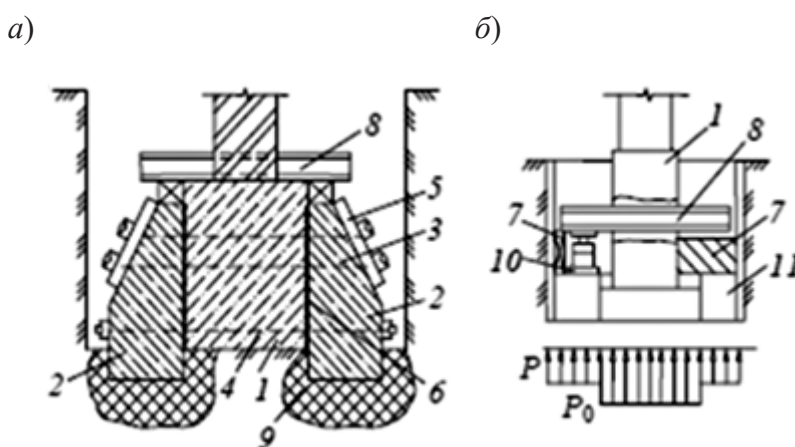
Способы усиления фундаментов предварительным обжатием грунта [5]:
